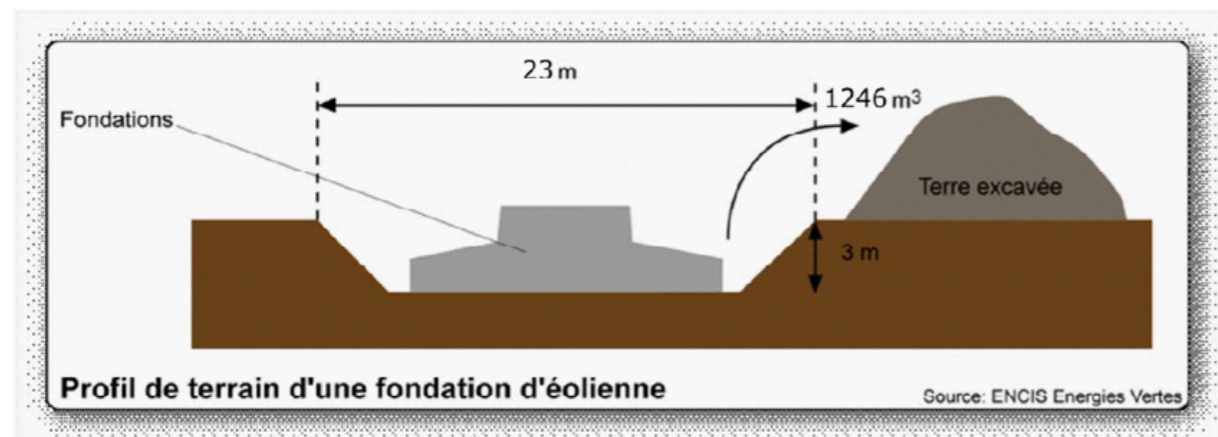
Profil de terrain d'une fondation d'éolienne.
